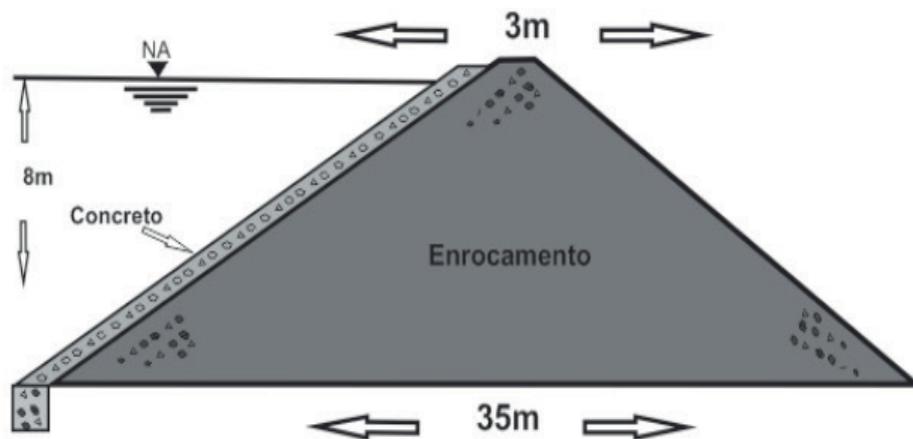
Proposta de taipa de barragem. Fonte: adaptado de Massad e Faiçal (2010).
